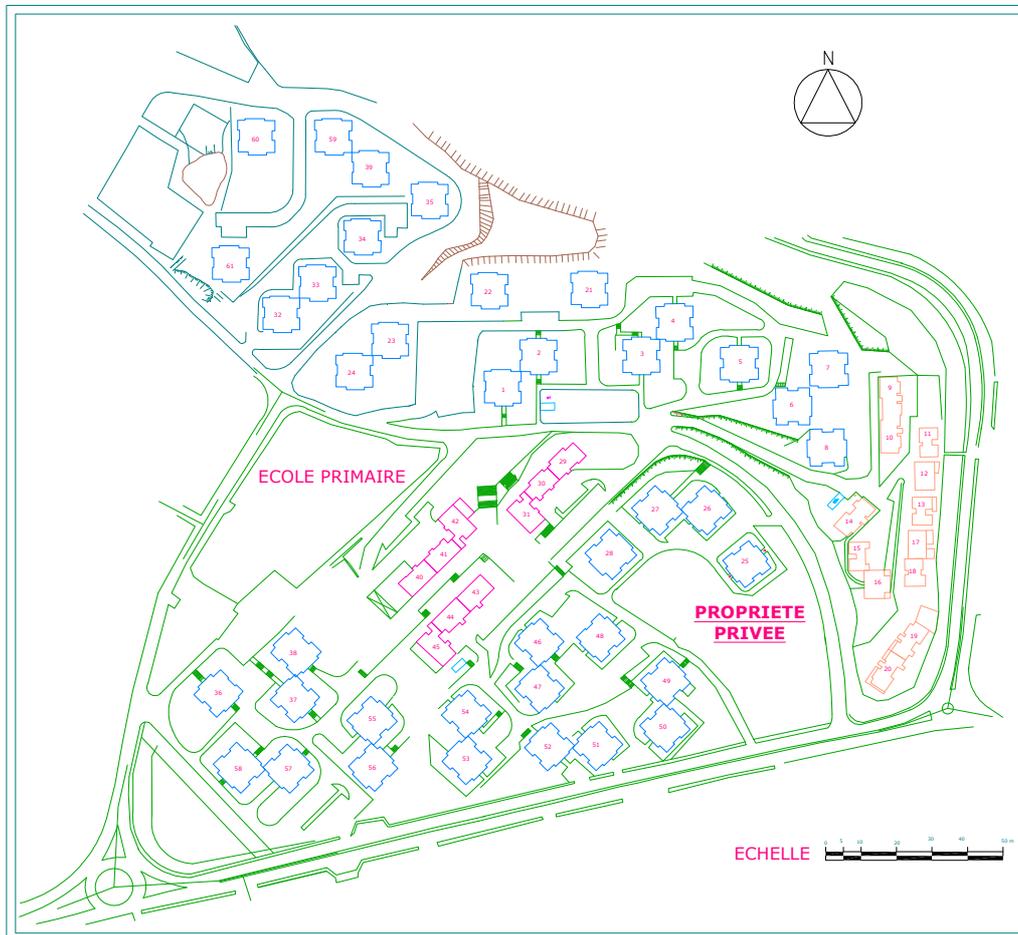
Plan de masse 918 logements collectif Theniet el Hadjar.
